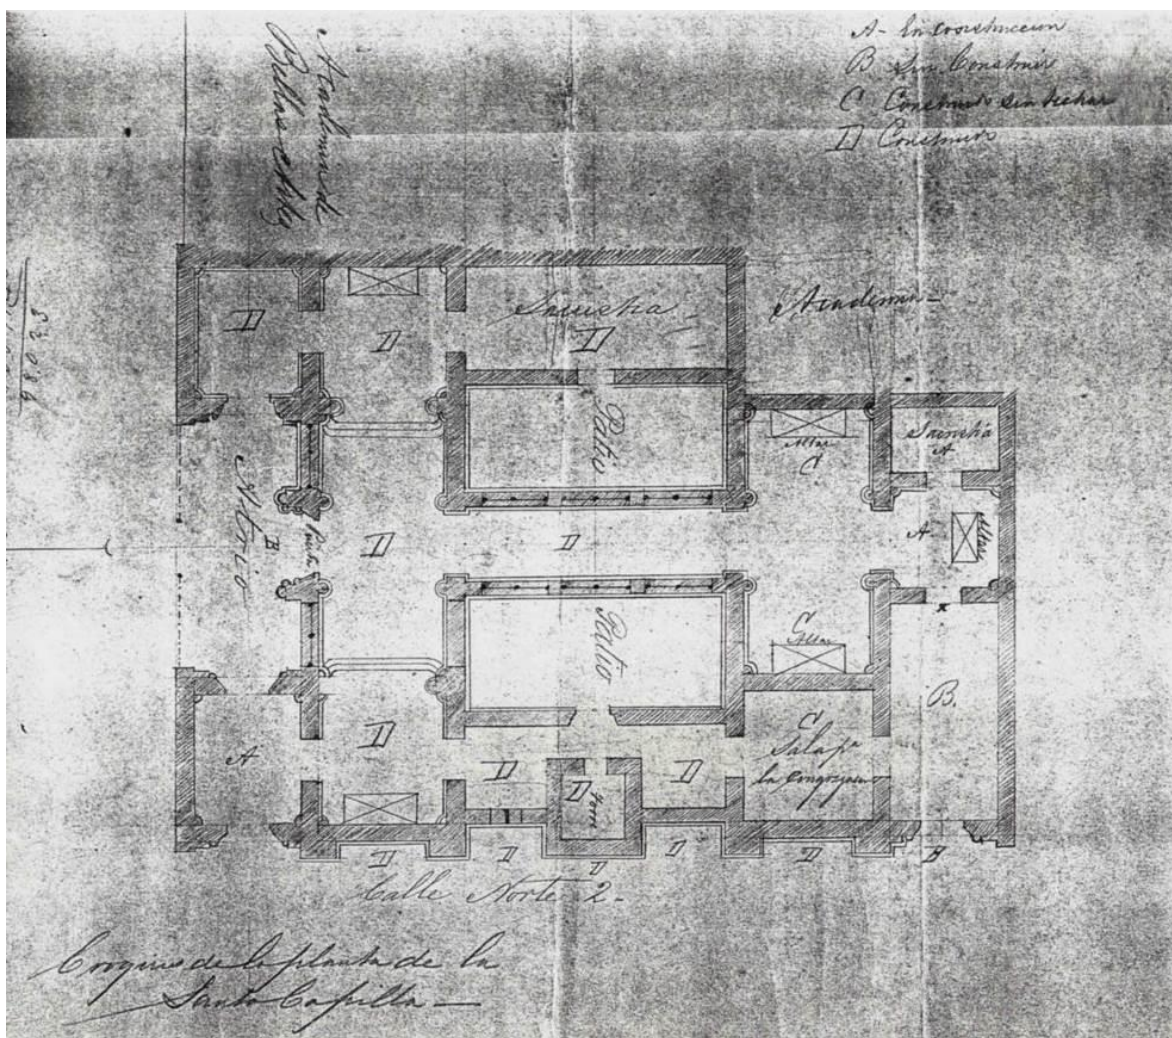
Croquis de la planta del ensanche de la Santa Capilla en proceso.
